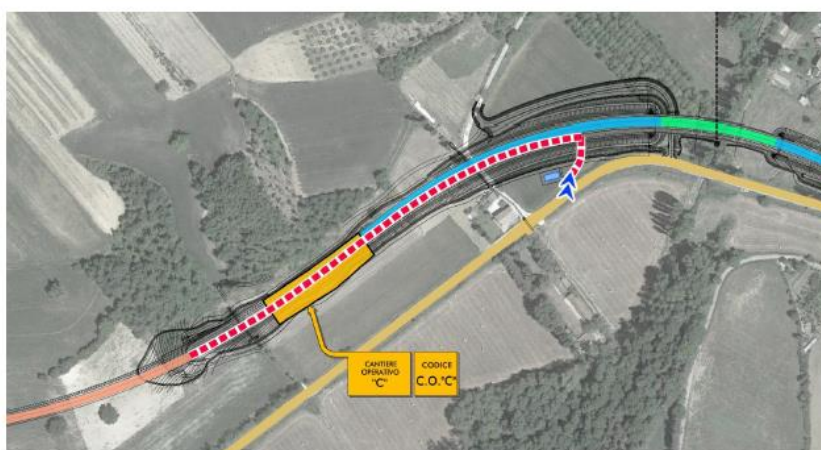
Planimetria con indicazioni della pista di cantiere per il collegamento all'imbocco Molinello Est (Estratto dall'elaborato T00CA01CANPL01A)
